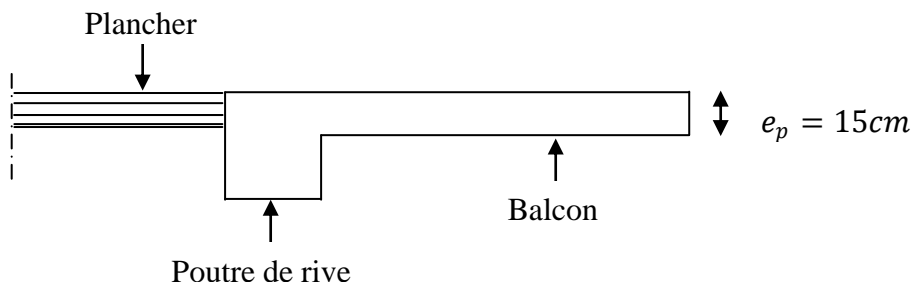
Coupe verticale détaillant la liaison balcon – poutre.
